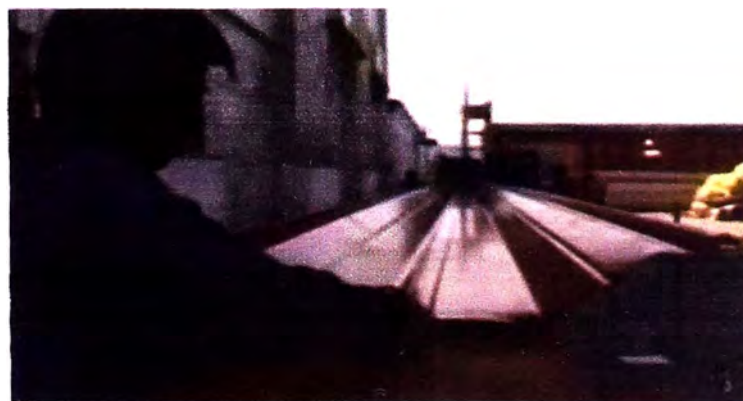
Perfil acanalado recto con la longitud del arco
